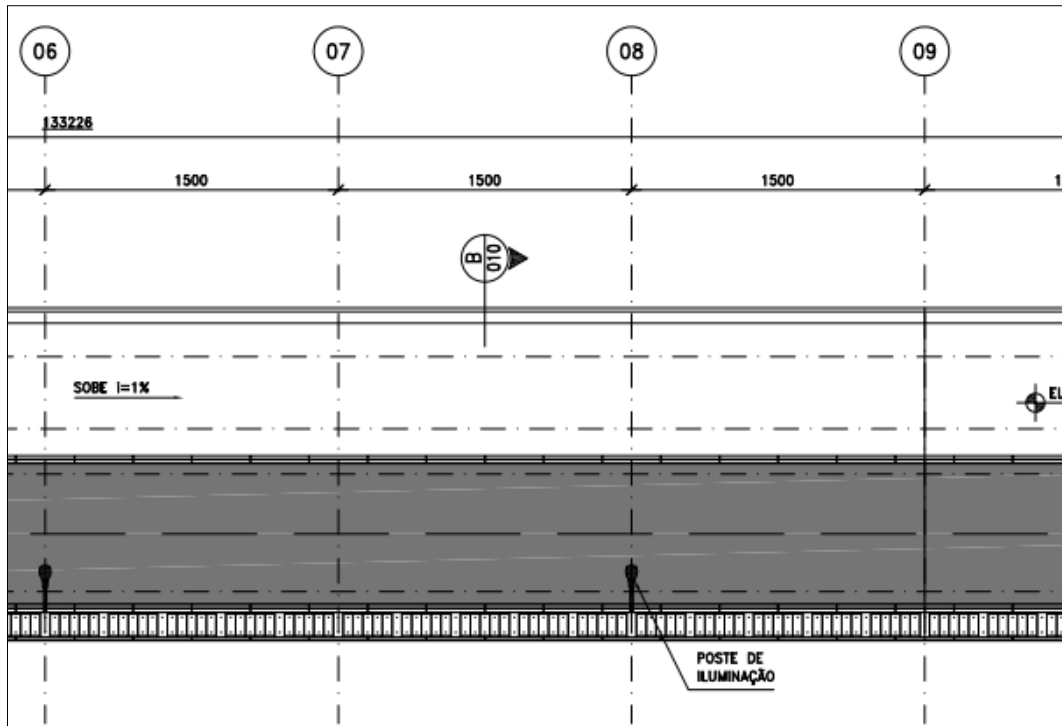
Ponte de Acesso - Trecho típico
